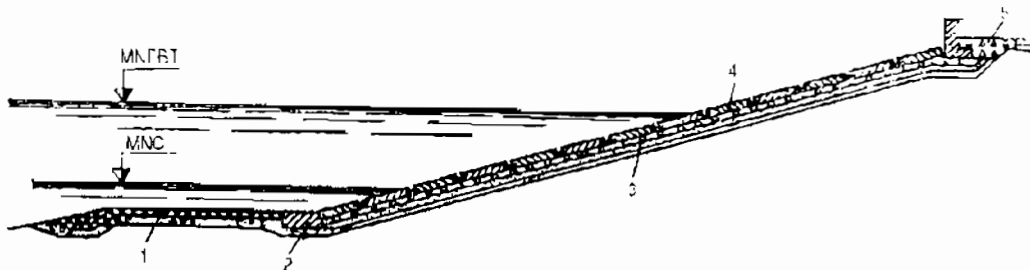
Sơ đồ gia cố mái dốc bằng đá đổ
